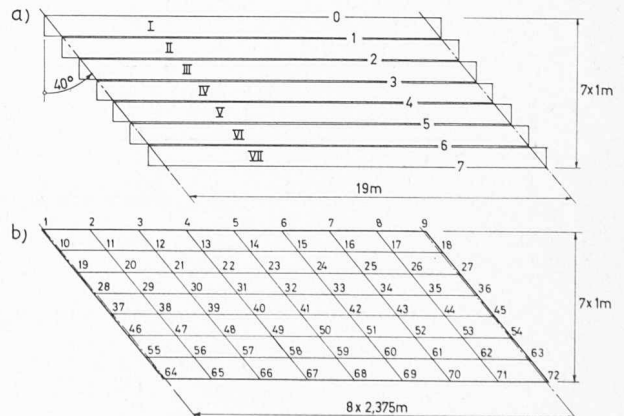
a) Pont biais formé de sept poutres-caissons KL 61-18.
